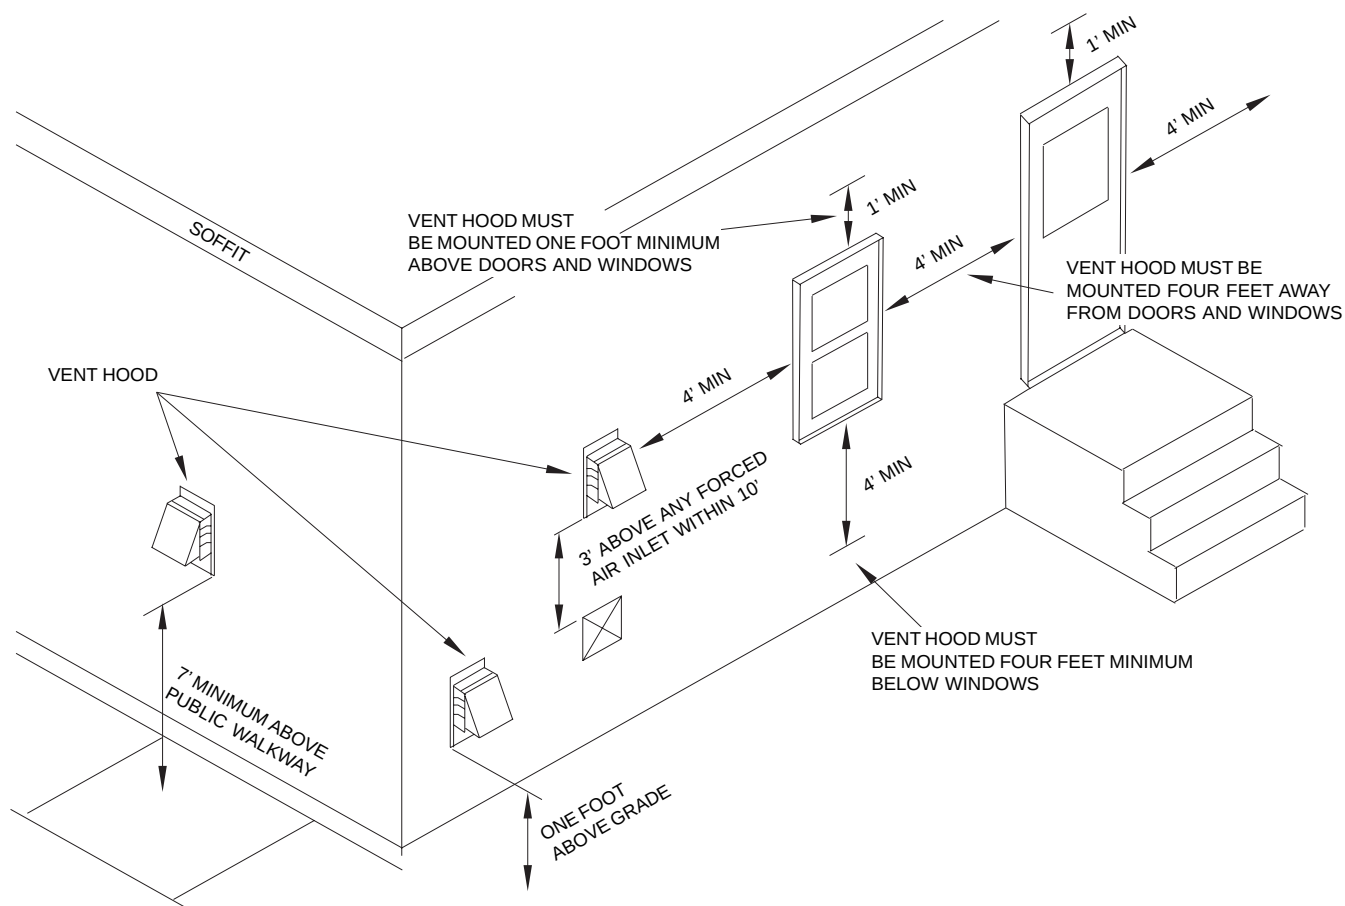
Emplacement des terminaisons de conduit d'évacuation sur un mur latéral
